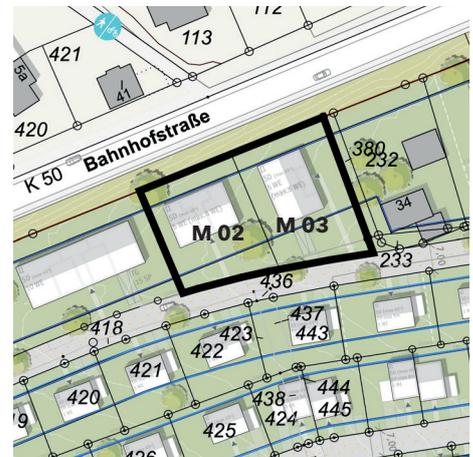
| Städtebaulicher Entwurf „Bahnhofshügel“, pbh Planungsbüro Hahm GmbH mit SWUP GmbH, 2023 mit Kennzeichnung der 4 Abschnitte
